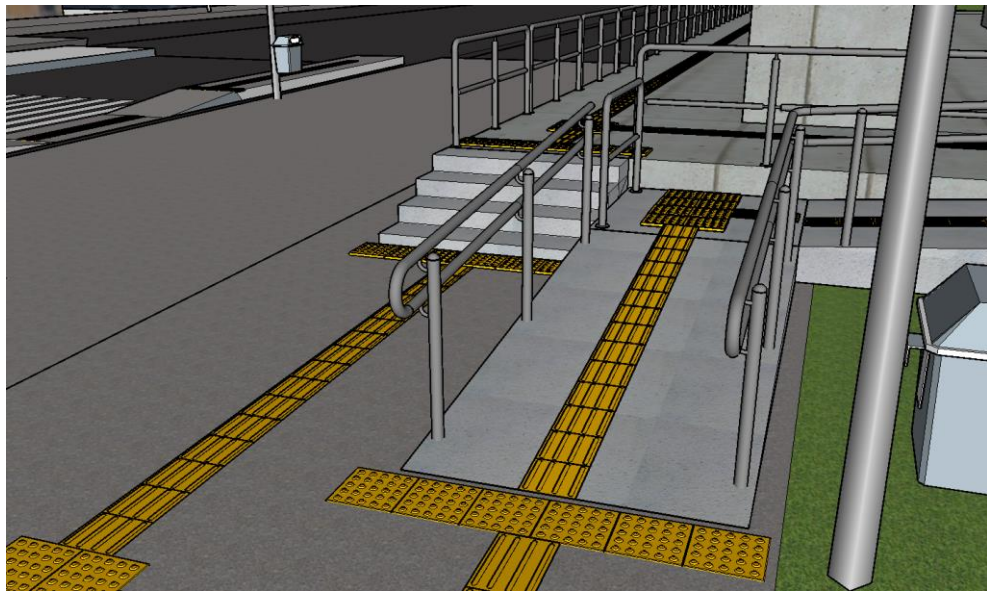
Vista frontal da rampa de acesso com detalhes do piso tátil instalado com fixação de corrimão na totalidade da rampa
